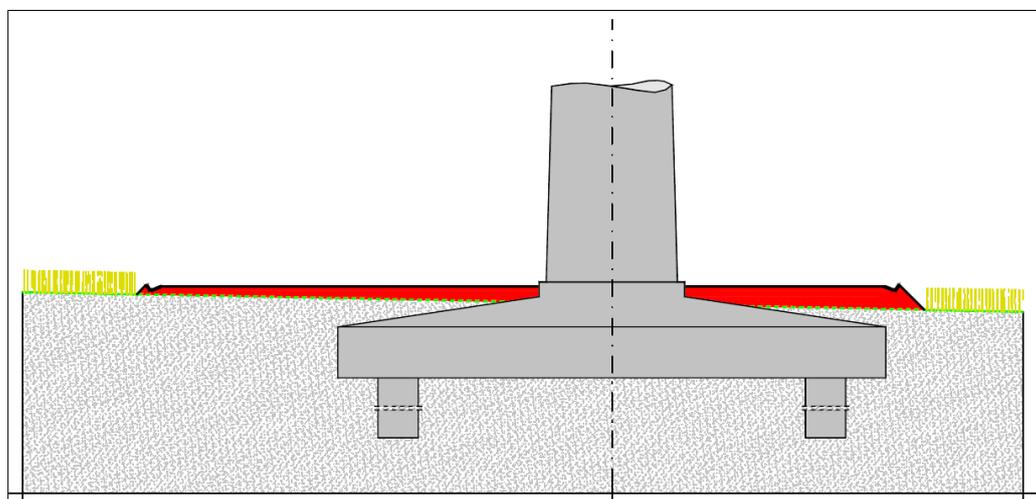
Esempio tipologico piazzola di montaggio e sezione di posa plinto di fondazione
